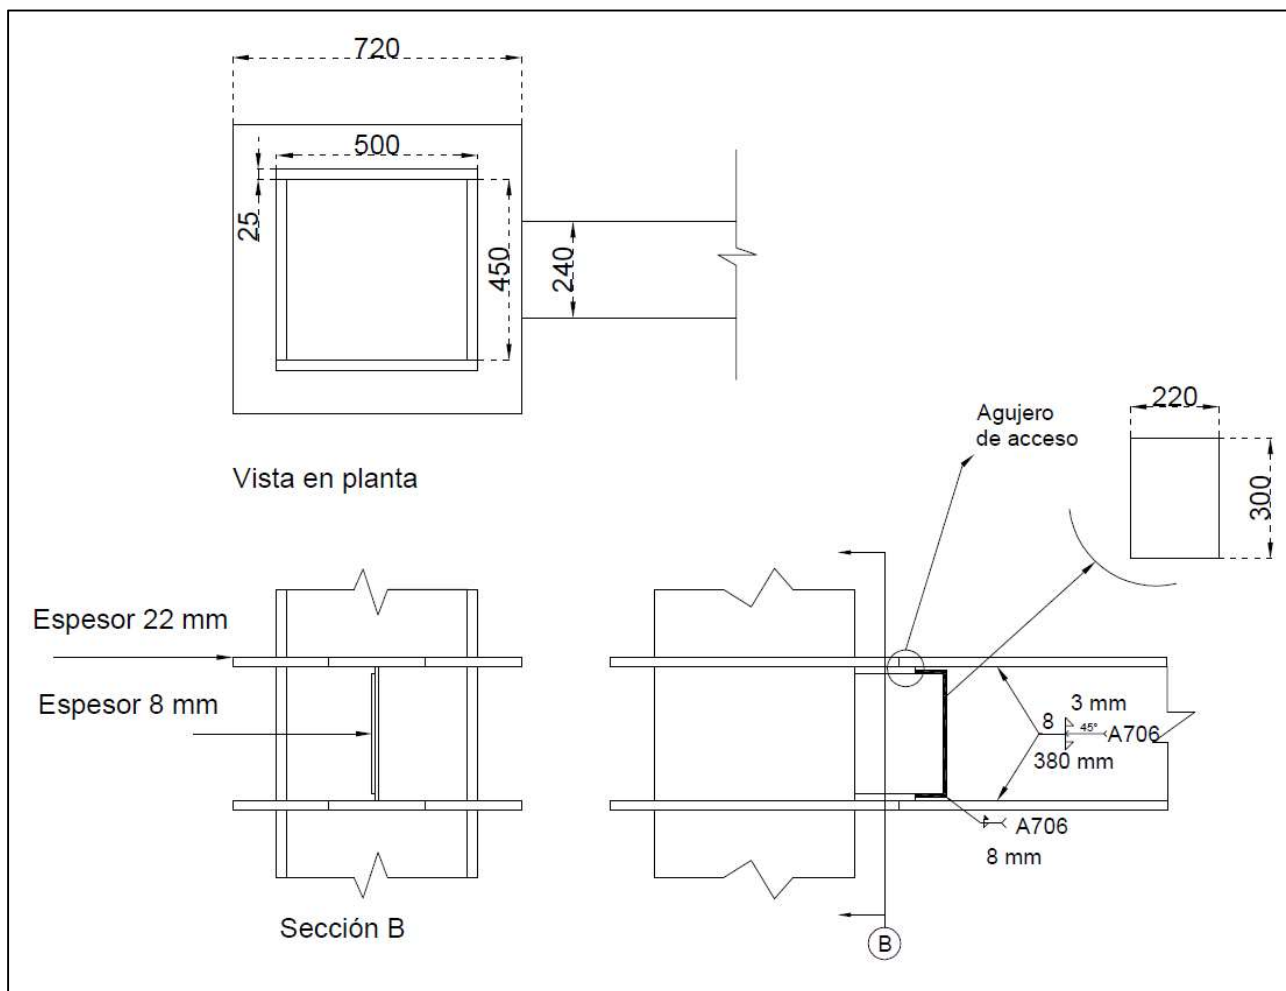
Detalle de conexión para espécimen DCL PC1. Fuente: propia.
